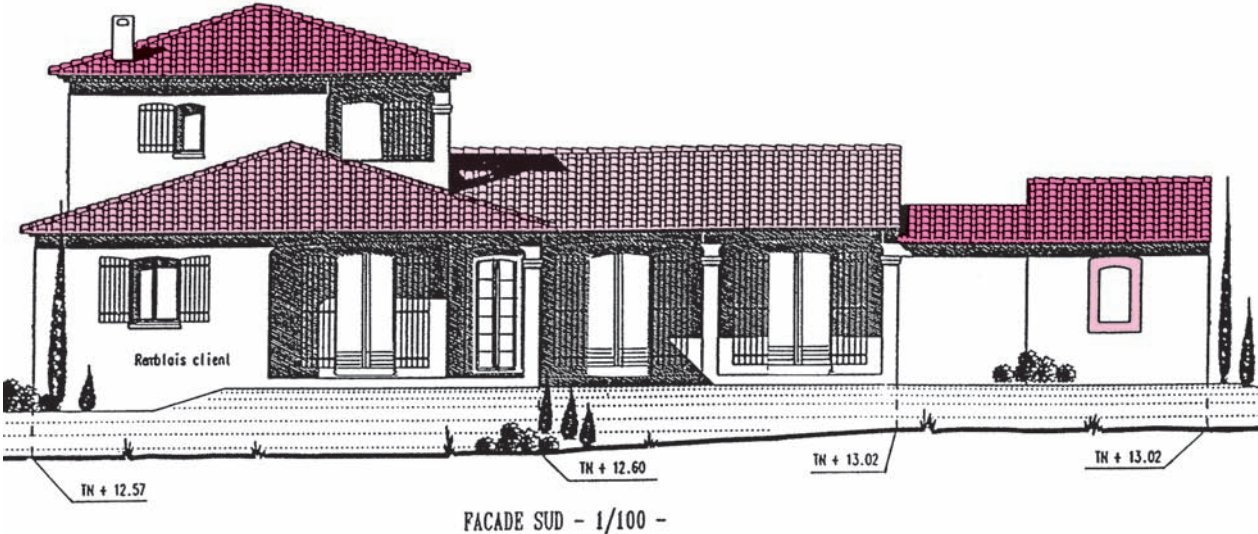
Vue à gauche sur les croupes du premier plan (à trois pans) et du second plan (tour à quatre versants)
